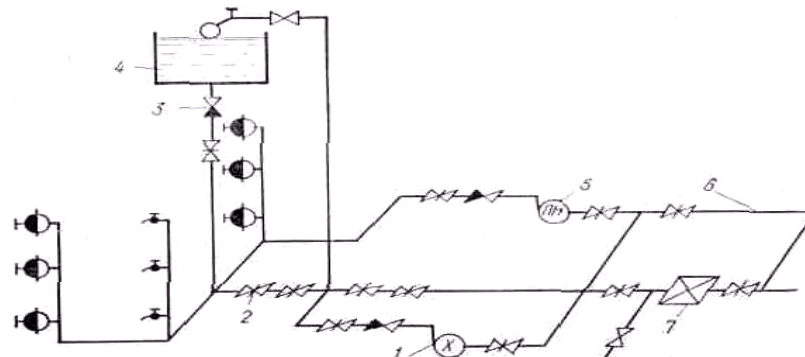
Схема водопроводу з водонапірним баком і насосами
